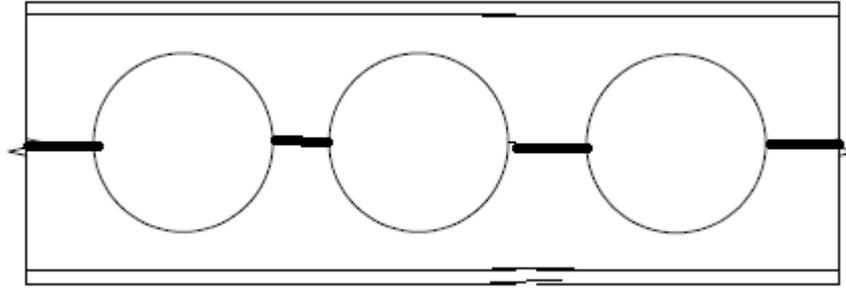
7. Ruine par écoulement du joint de soudure
